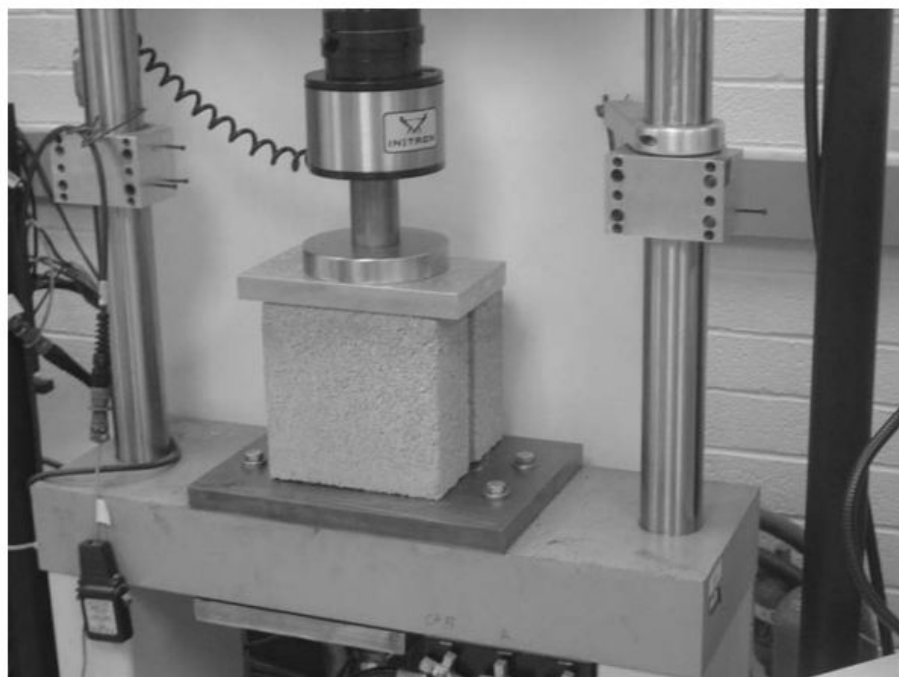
Prueba de compresión de un elemento de mampostería de hormigón.
